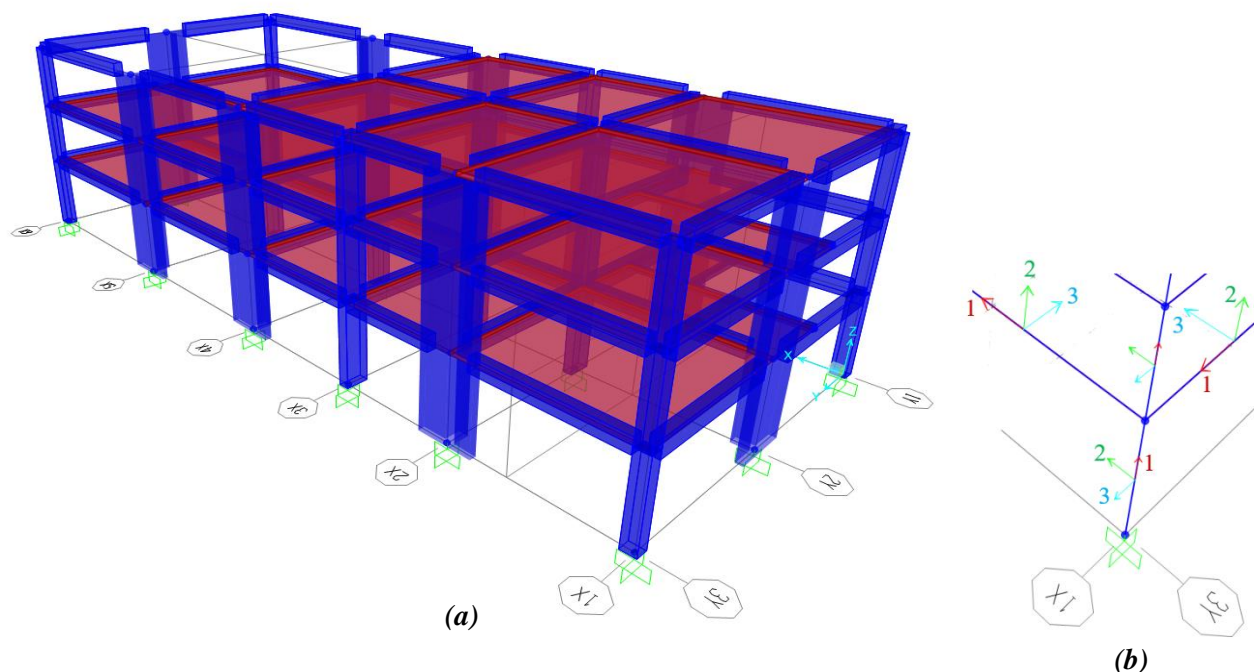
(a) Modelo tridimensional de edificación de tres niveles. (b) Orientación de los ejes locales en los elementos estructurales.
